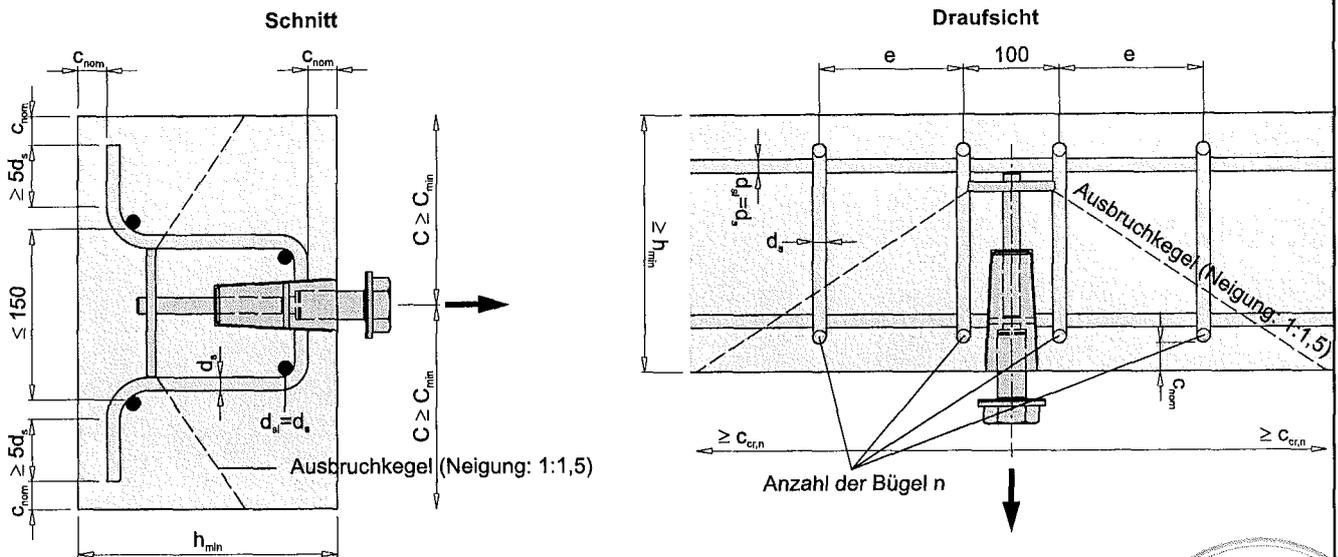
Einbausituation Stirnseite - Zugbeanspruchung mit Rückhängebewehrung - Bewehrungslage
